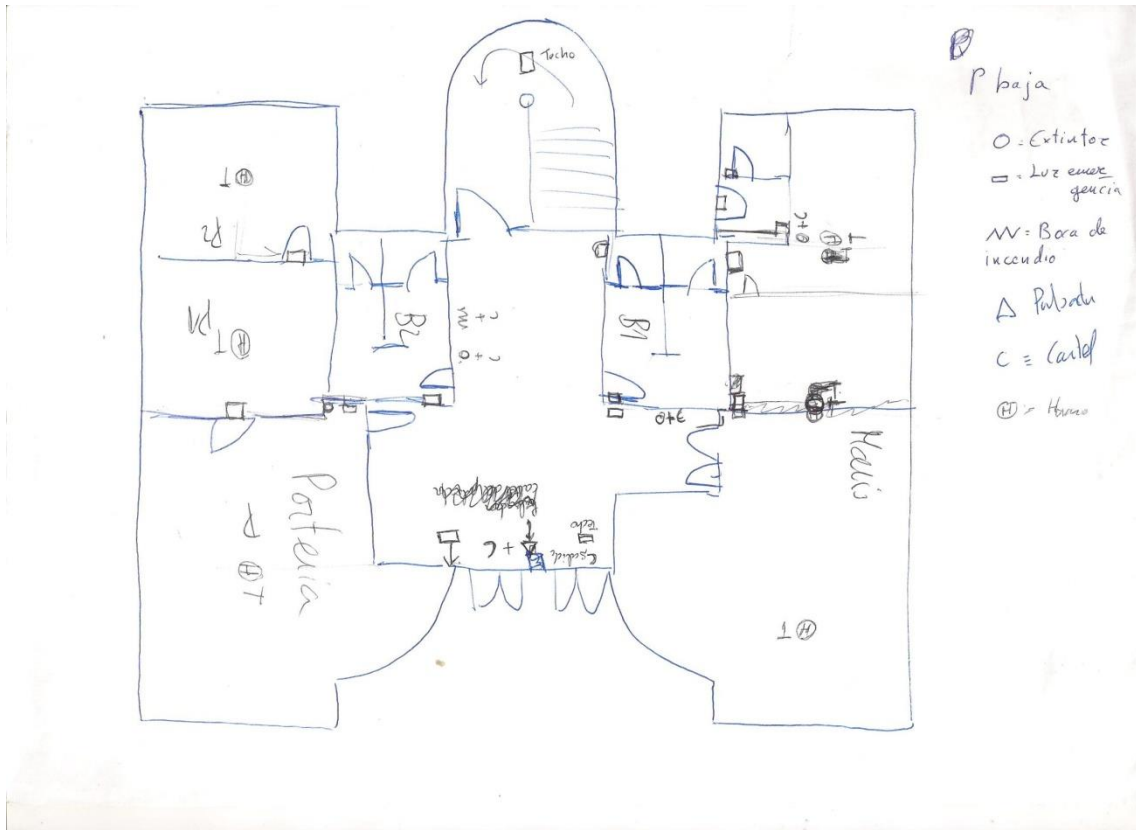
Croquis de la planta baja con los equipos de la instalación contra incendio del edificio. Fuente: Elaboración propia.
